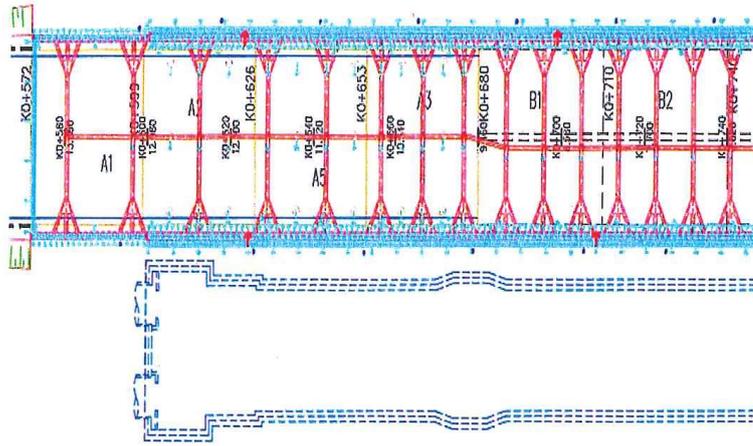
基坑平面图 (地铁 6 号线中山大学站段)
